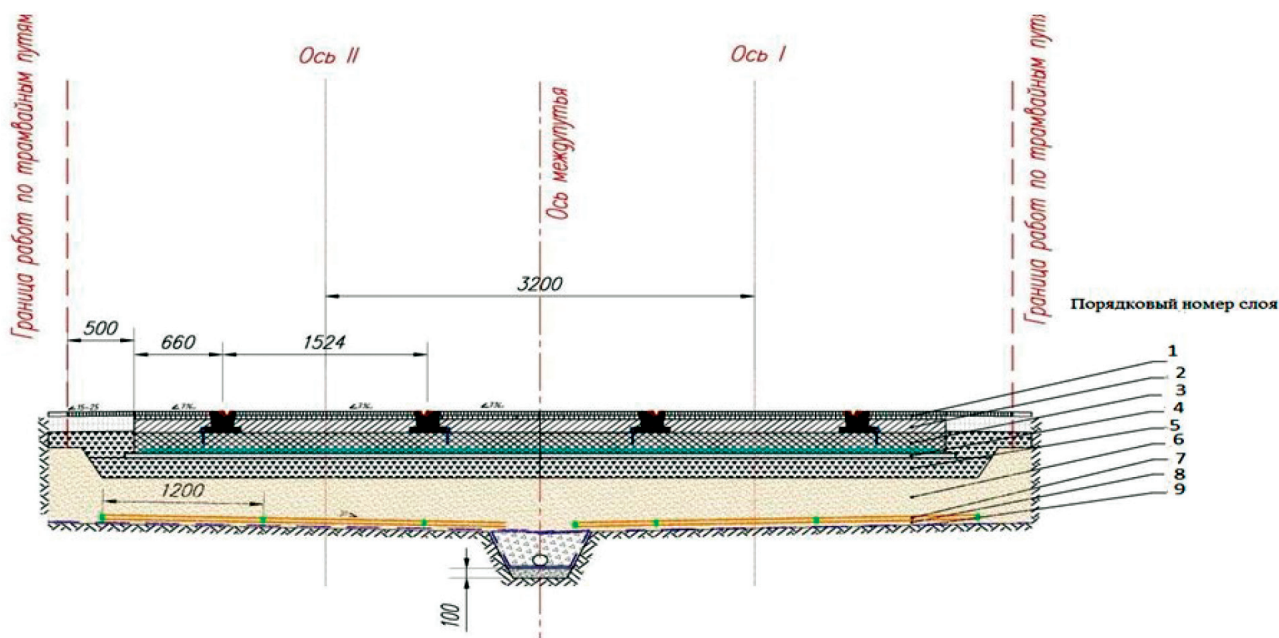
Конструкция трамвайного пути на основании из железобетонной плиты, залитой в 2 слоя:
